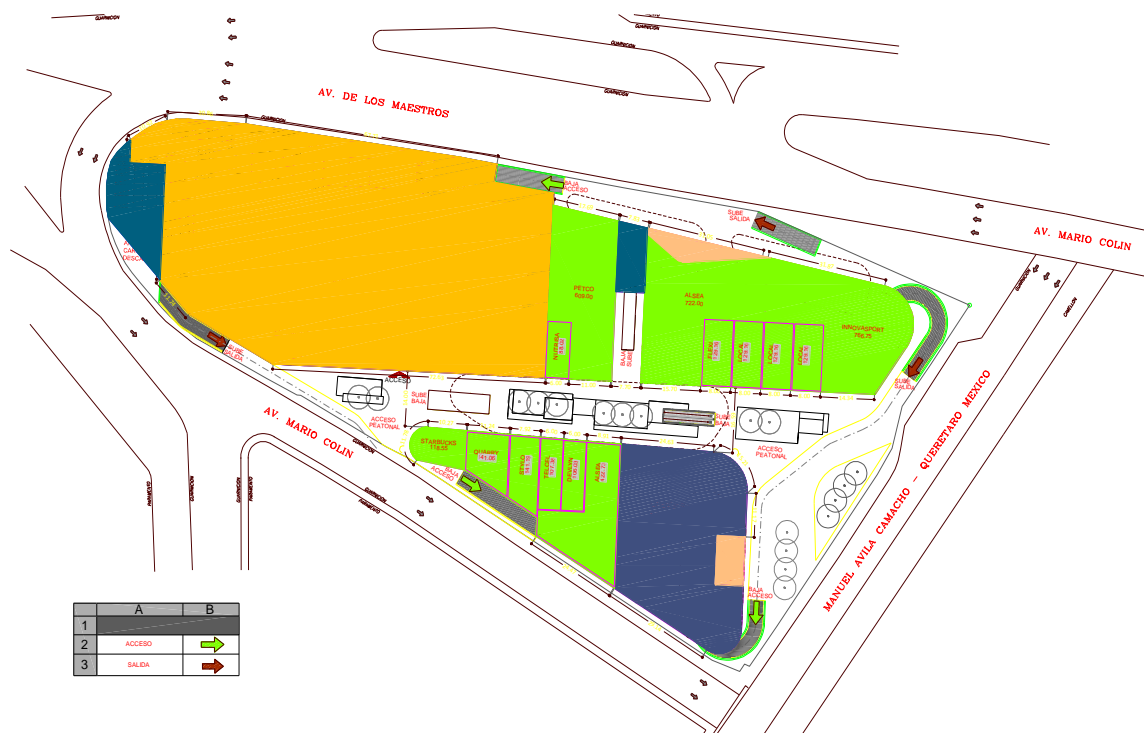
Ubicación del predio de proyecto y planta baja.
